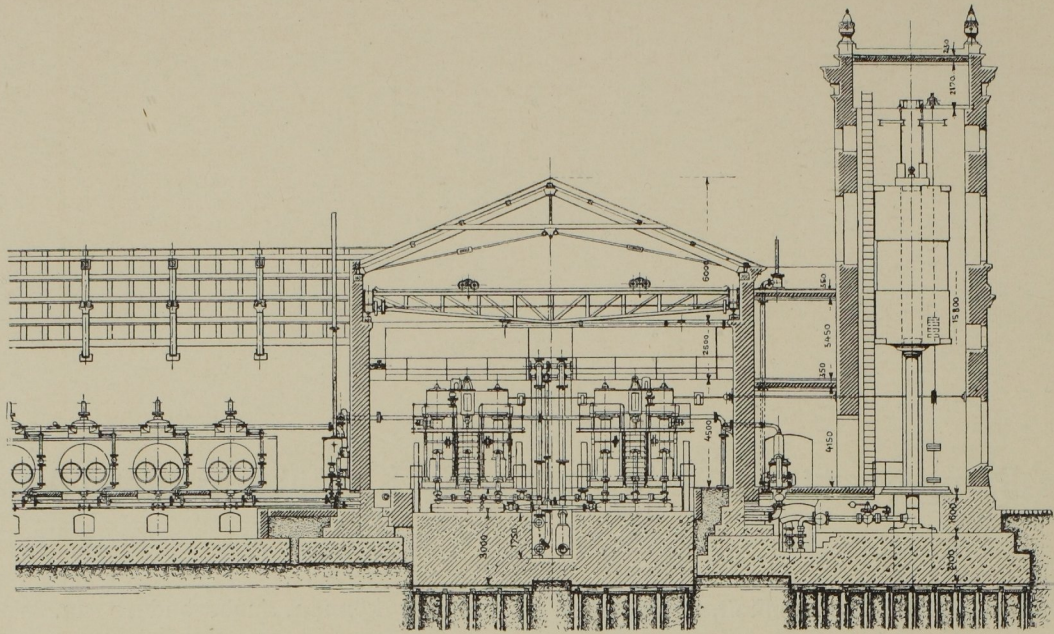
Längsschnitt durch das Maschinengebäude. Massst. 1 : 300.
